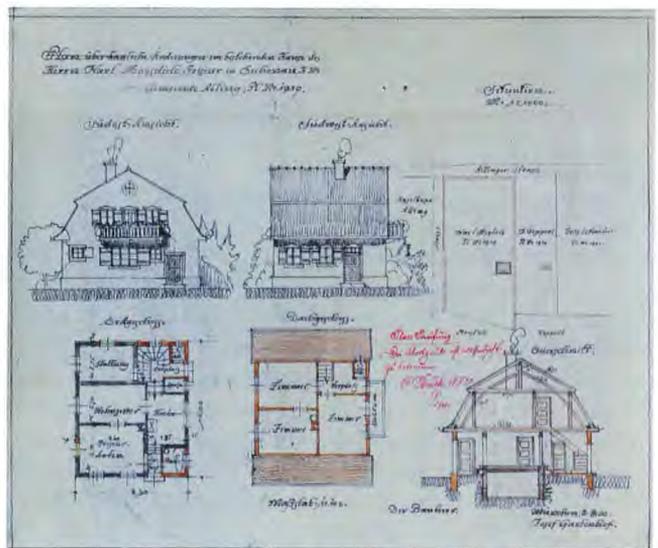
Plan über bauliche Änderungen im bestehenden Hause, München 2.III 1920
